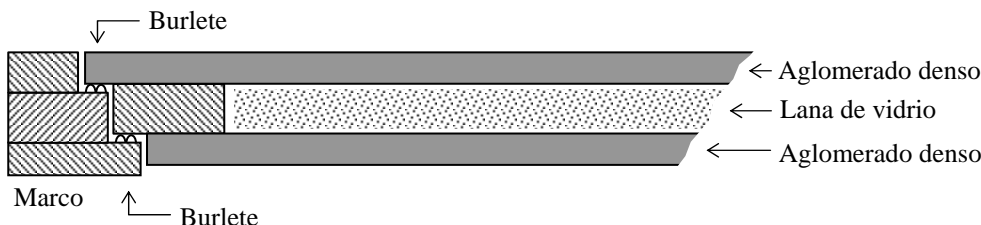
Detalle constructivo de una puerta con características acústicas mejoradas (corte según plano horizontal). La pérdida de transmisión es superior a la de una puerta placa convencional.
